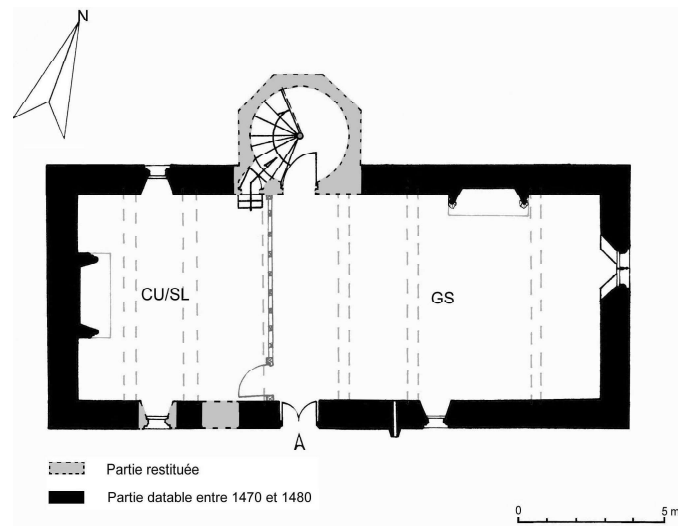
Perriers. Plan restitué du rez-de-chaussée entre 1470 et 1480.
